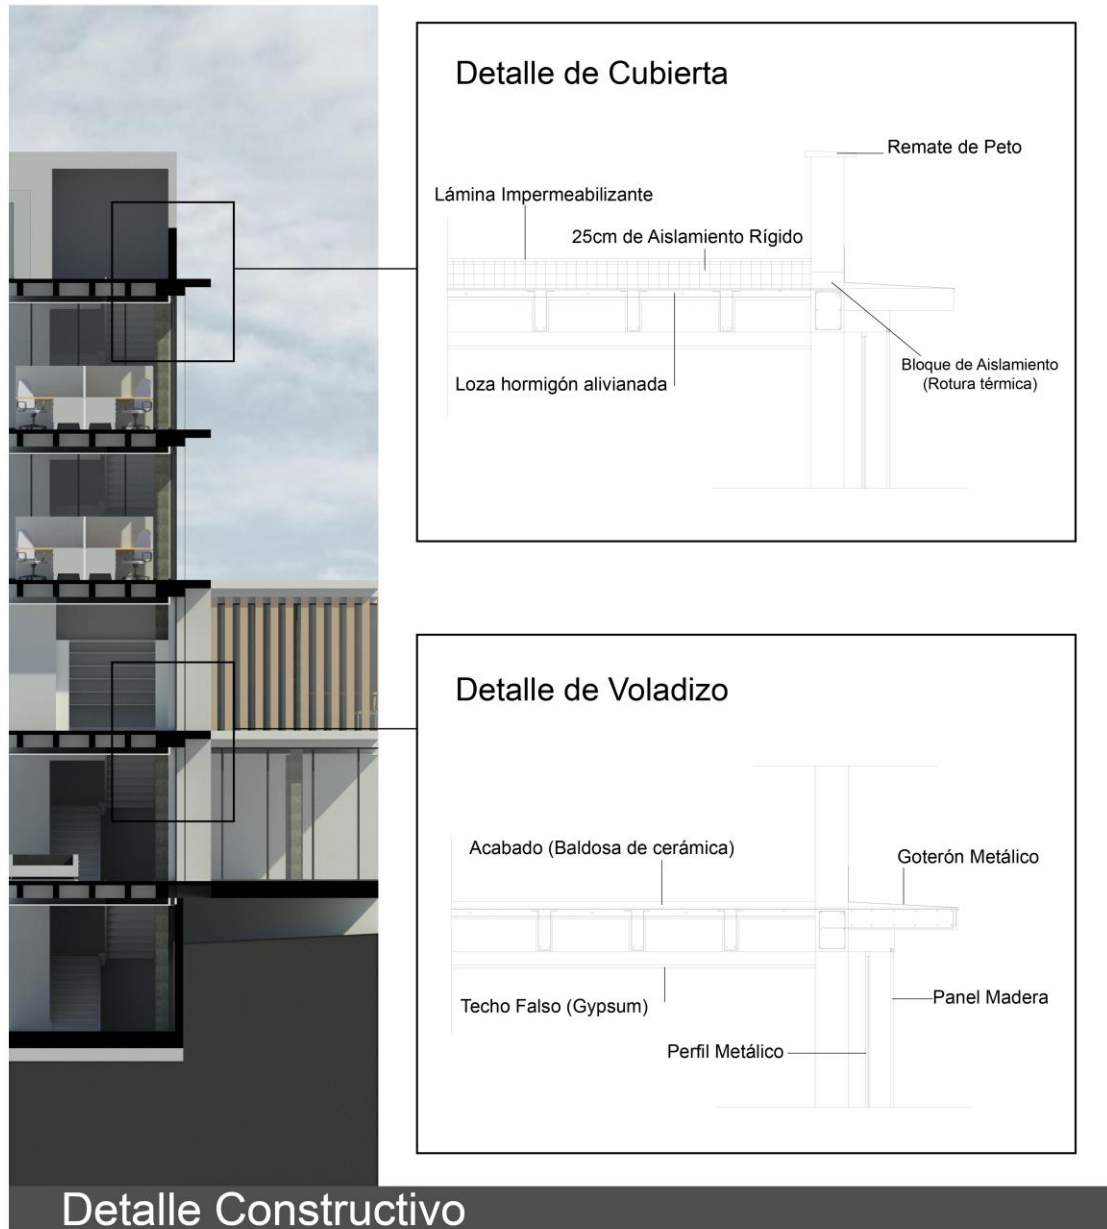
Detalle Constructivo de Fachada. Elaboración Propia
